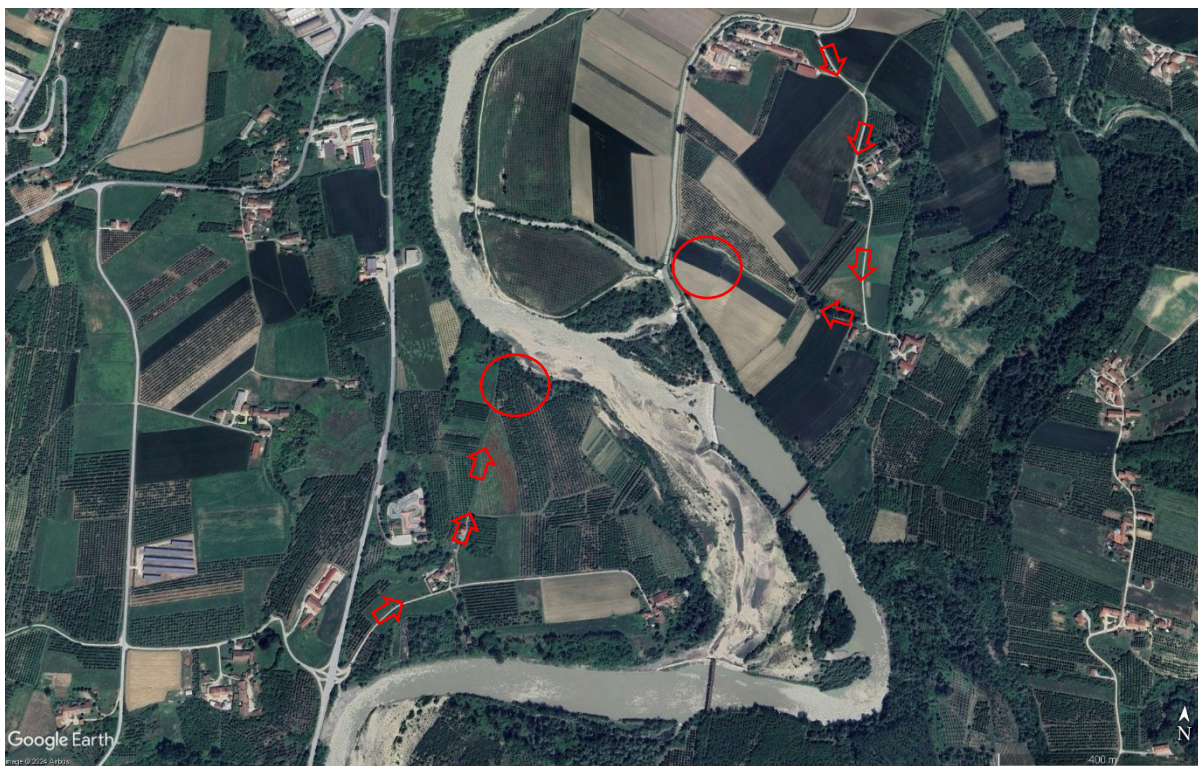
Individuazione delle aree di cantiere e della viabilità di accesso
